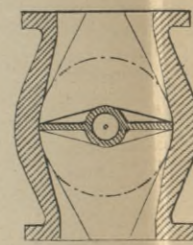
Joint étanche avec bande en caoutchouc. (Echelle de 0^m.10 p. mètre)
